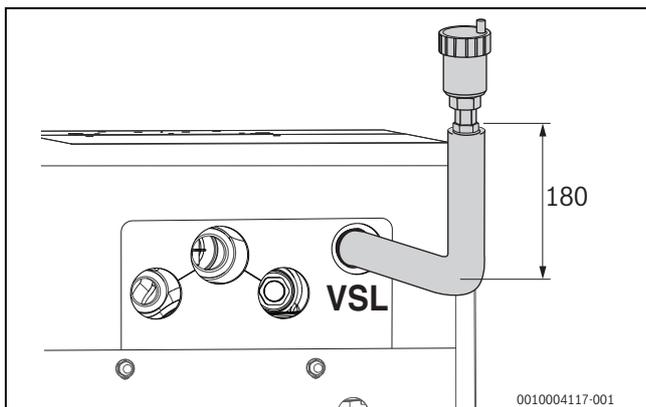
Raccorder le purgeur au départ de sécurité (dimensions en mm)
